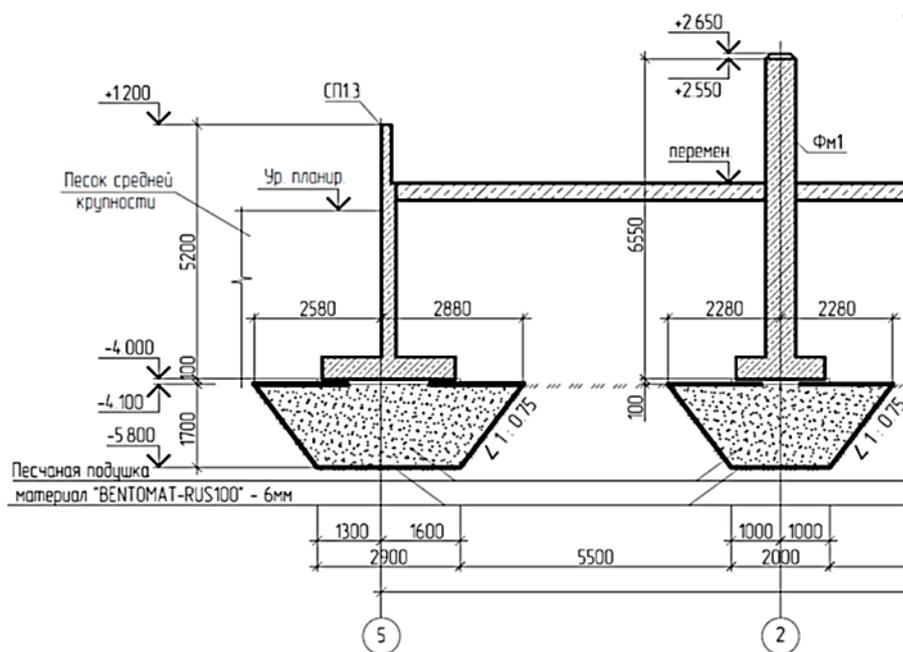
Схема замены просадочного грунта песчаной подушкой
